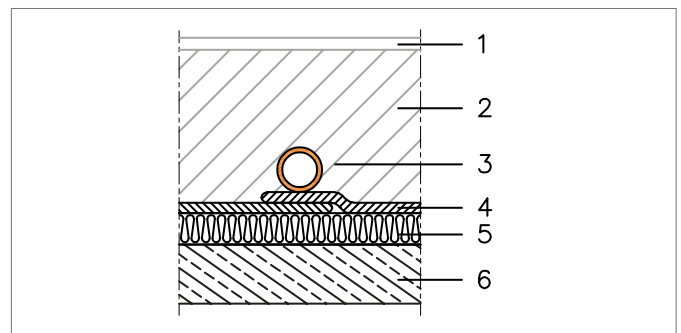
Prinzipaufbau Klettsystem RAUTHERM SPEED plus für Niedrigaufbau mit zusätzlicher Wärmedämmung
